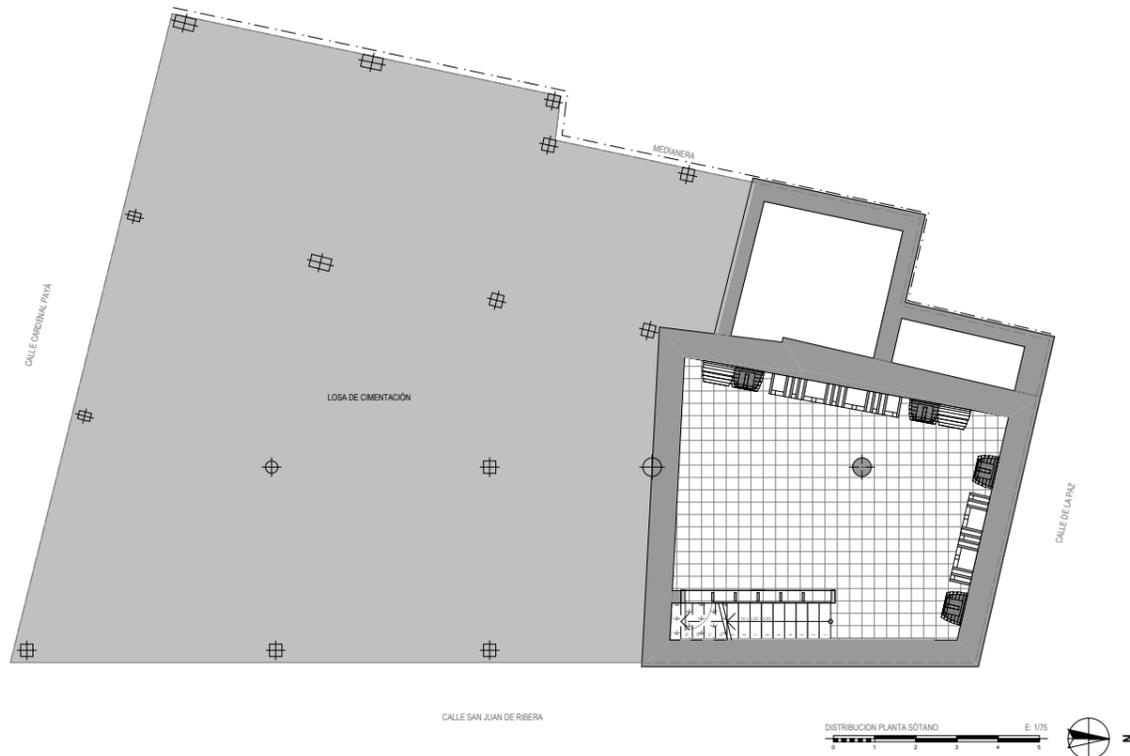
Planta Sótano. Ubicación pavimento barro cocido.
